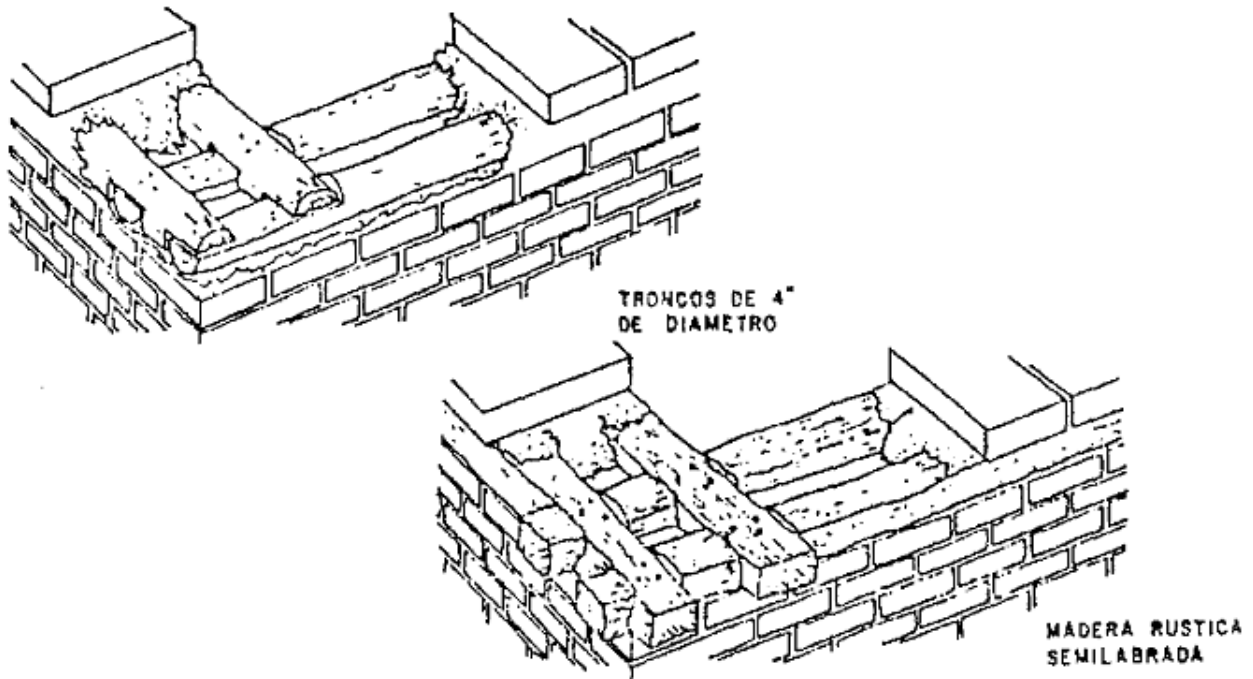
Refuerzos horizontales. (Fig.: Manual para construcción con adobe 1993)
